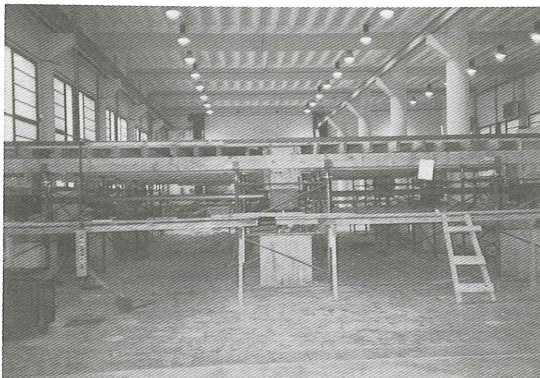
Losa encofrada. Se observan los macizos de apoyo y la estructura de atirantamiento de la base de los pilares.
